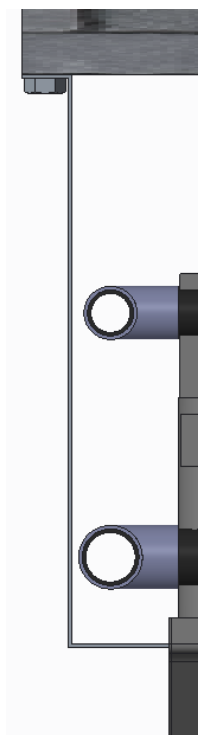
Vista en planta de l'embellidor, ancorat a la façana.
